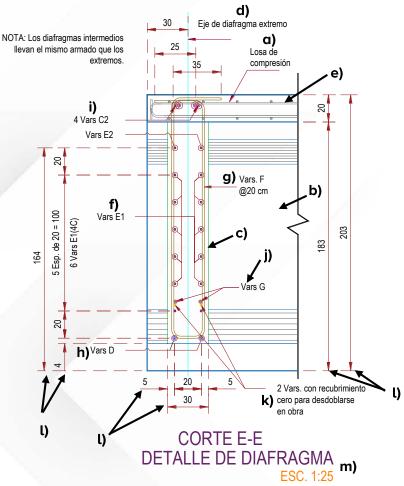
Ejemplo de corte E-E, detalle de diafragma
